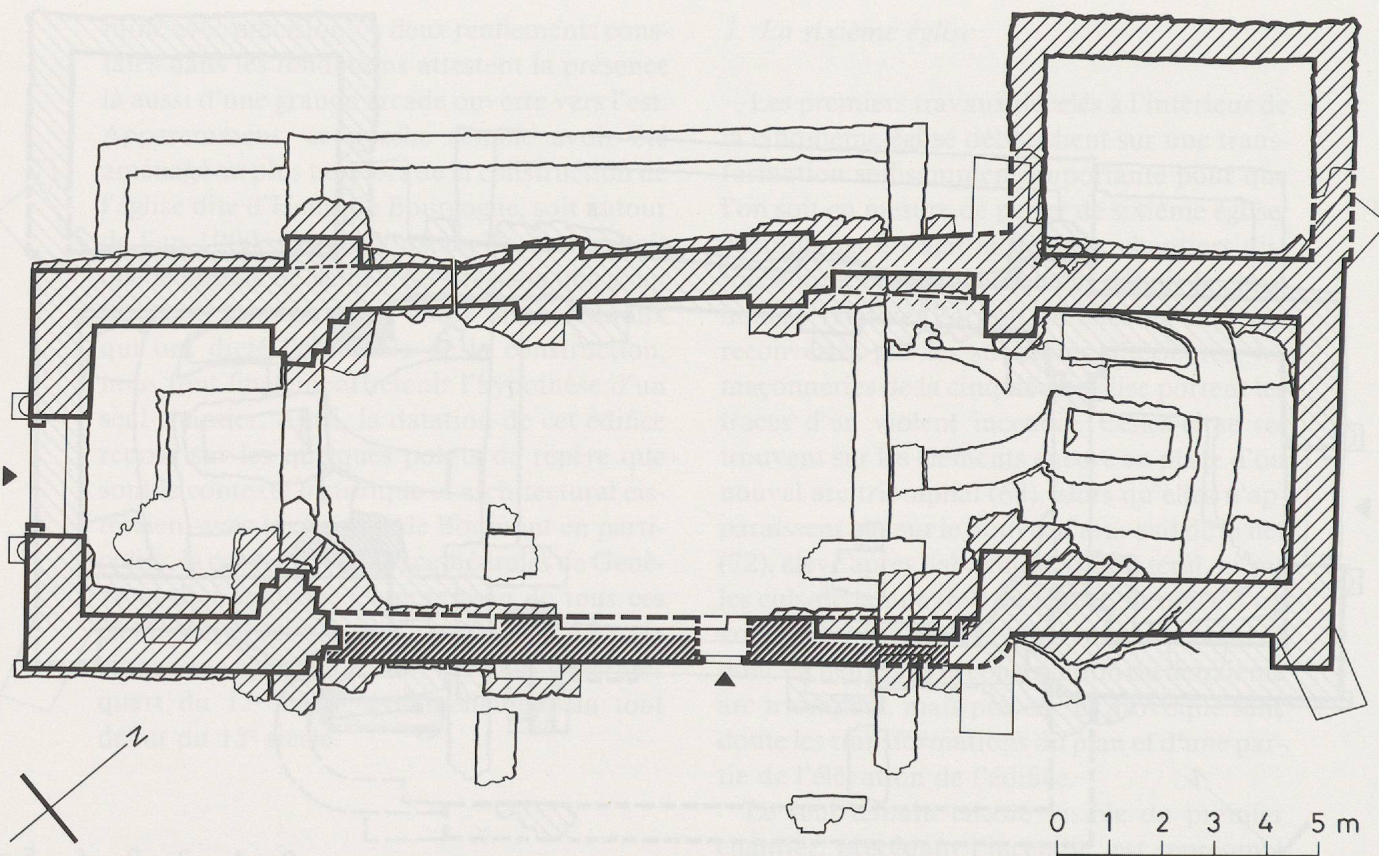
Plan reconstitué de la sixième église. Ech.: 1:150.
